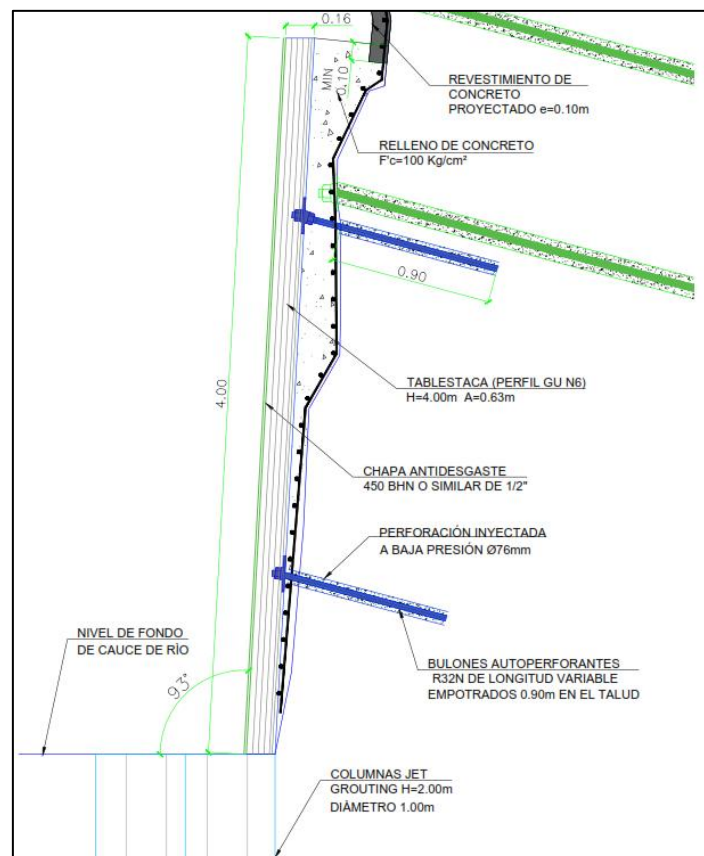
Detalle en sección transversal de la defensa proyectada. Fuente: Elaboración propia.
